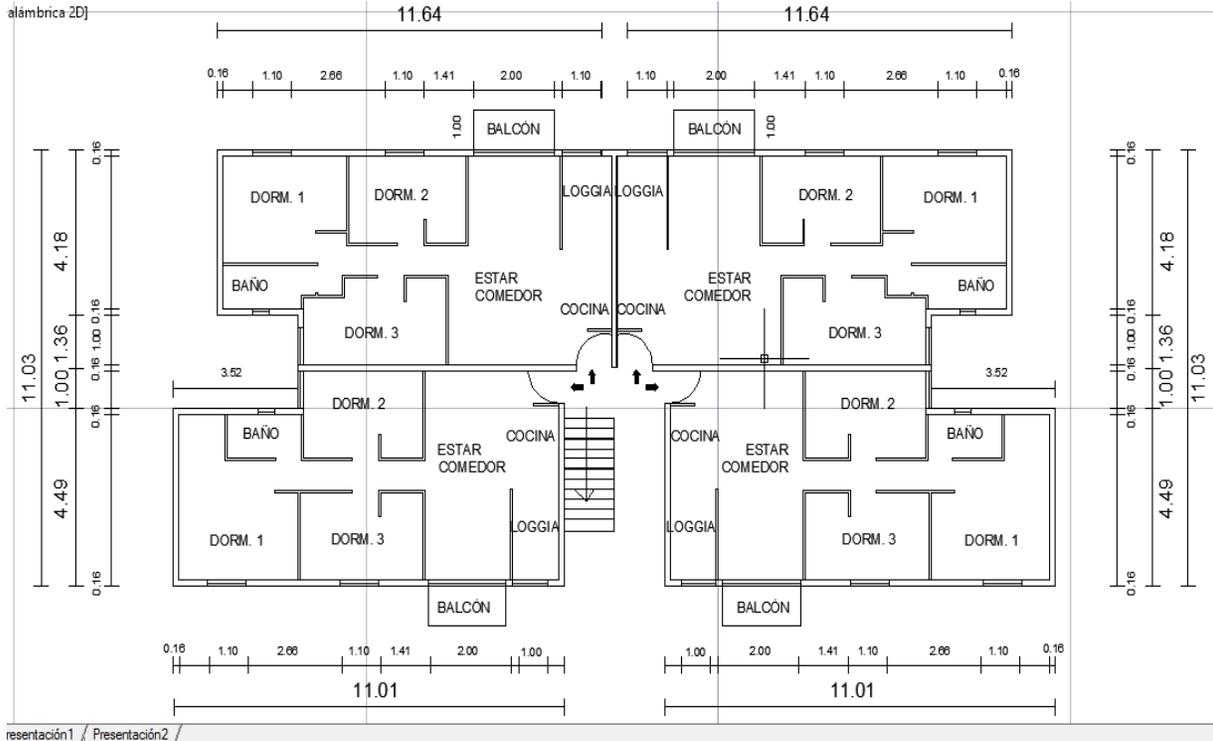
Planta Edificio Meseta del Gallo II.
